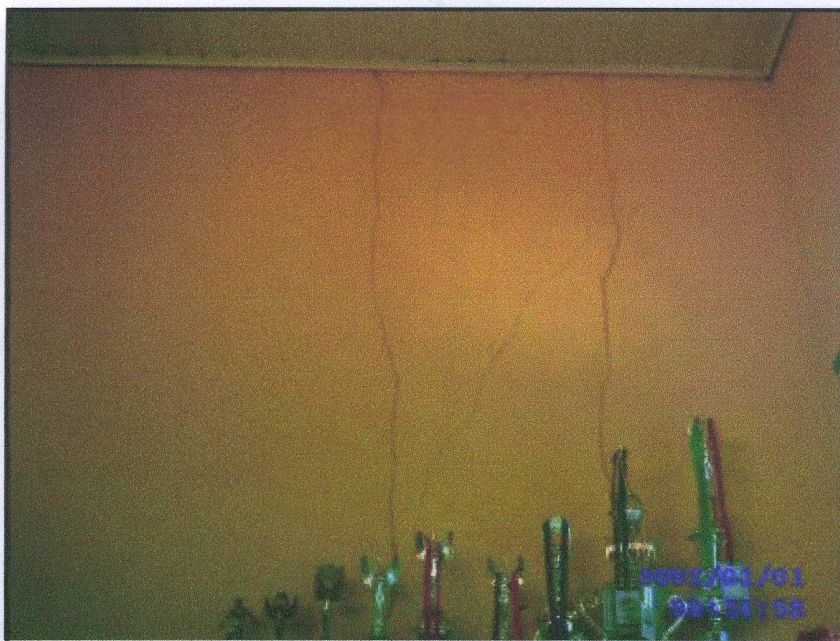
109 – Fissuras na parede interna da sala dos professores.
